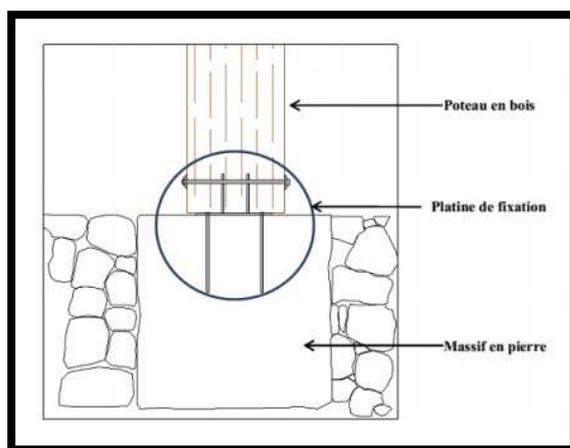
ancrage poteau en bois avec la fondation en pierre
